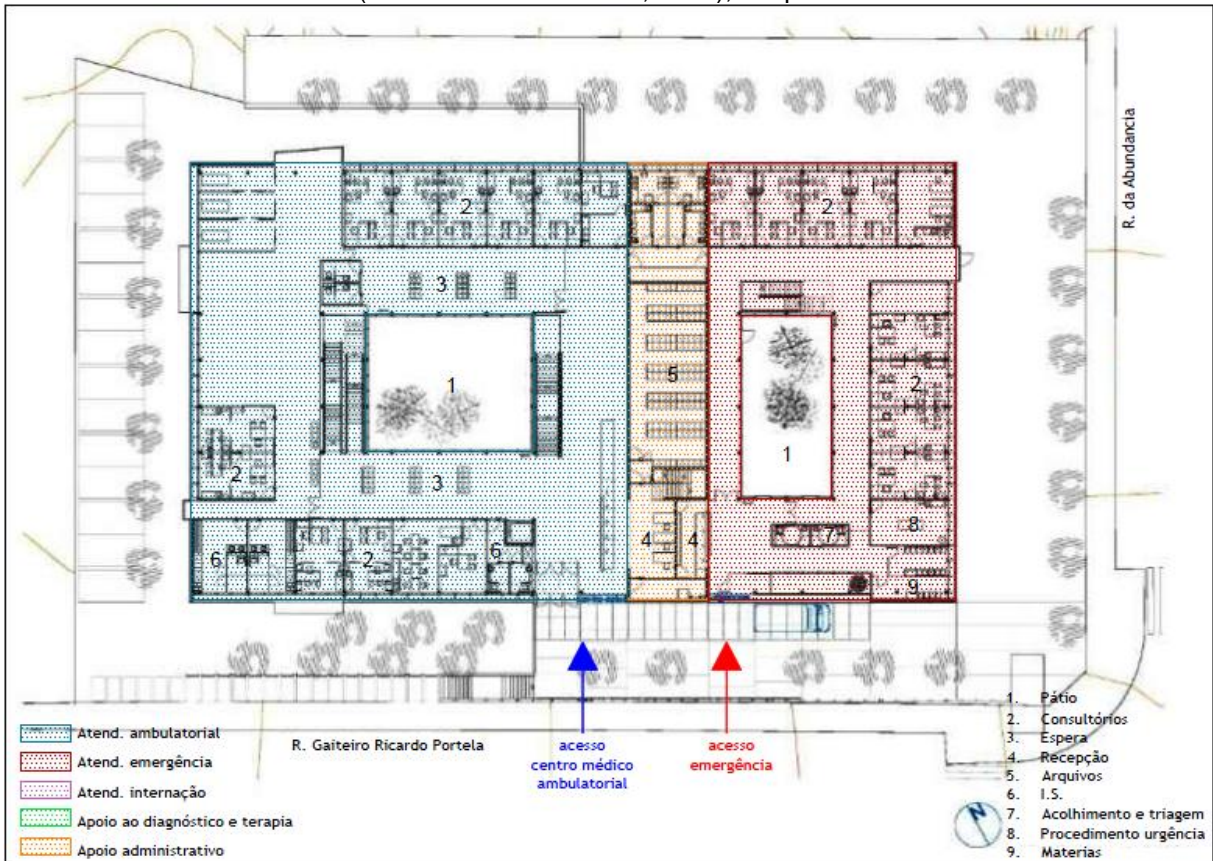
Planta pavimento intermediário (FONTE: ROSENBERG, 2011), adaptado
